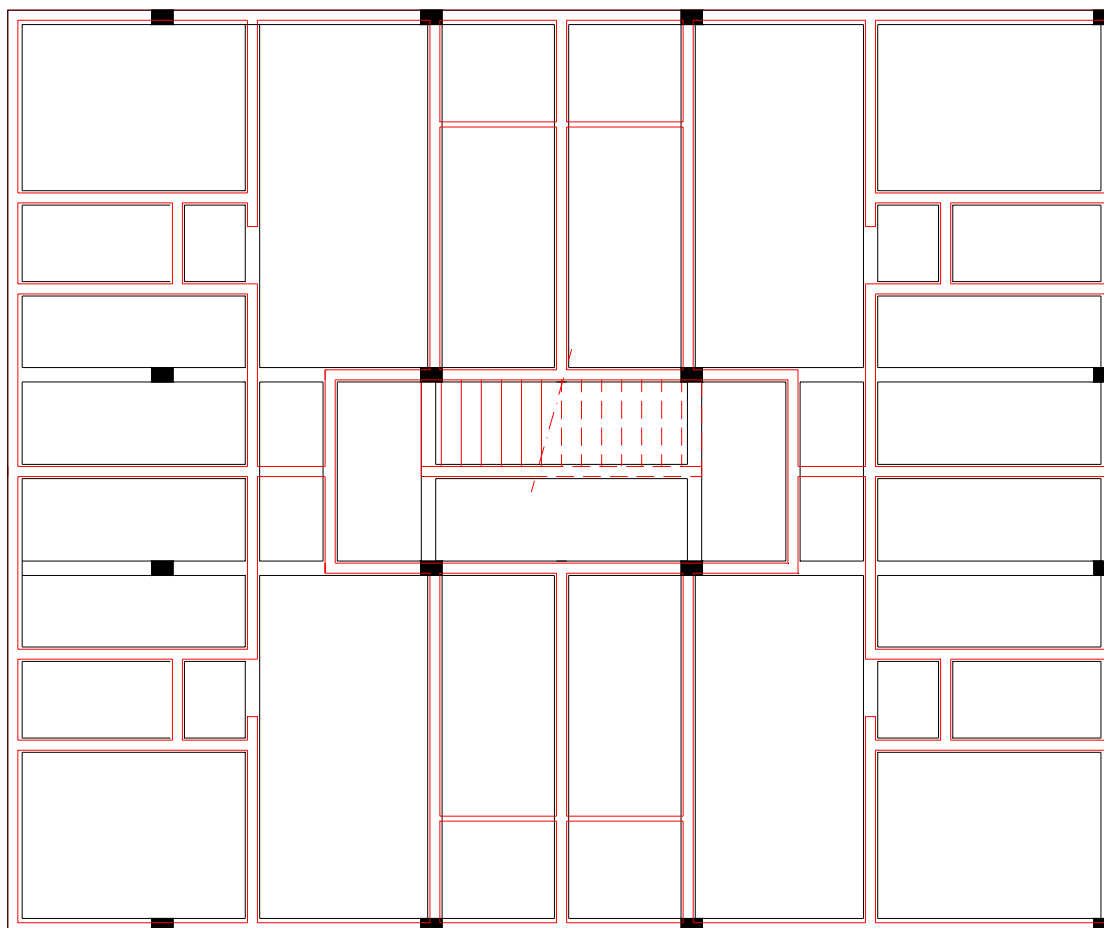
Prédio “M” – Opção 2 – Superposição das alvenarias do pavimento tipo sobre a estrutura
